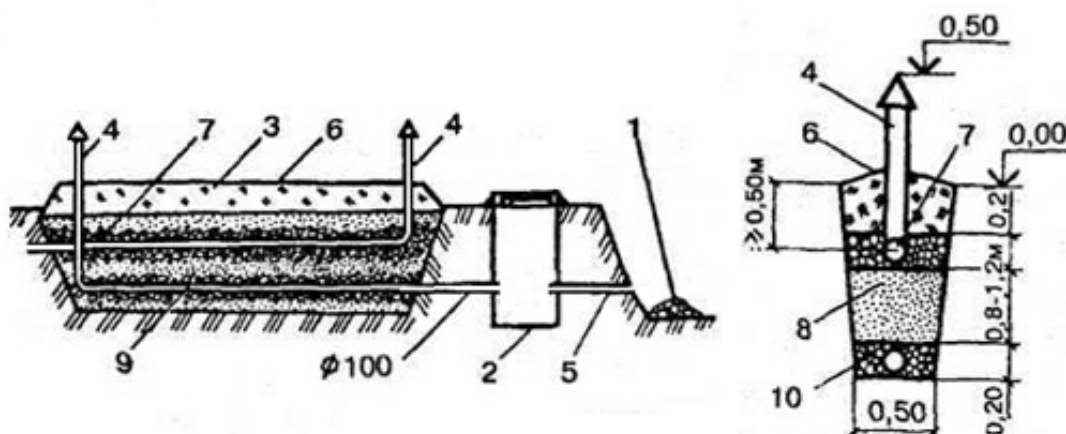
Поля фильтрации с отводом очищенной воды: 1 - каменная наброска 2- распределительный колодец 3- насыпной грунт 4-Стояки вентиляции 5- выходная труба 6- рулонная гидроизоляция 7- оросительная система 8- песчаный фильтр 9- дренажная система 10 – щебеночный слой
